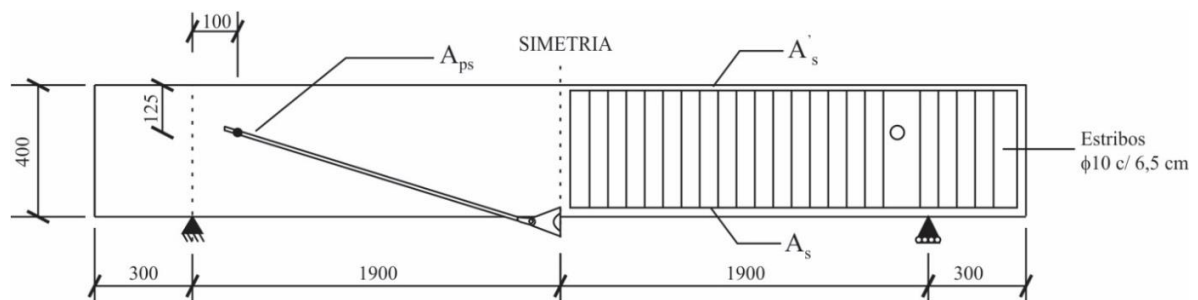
Esquema estático e armaduras para as vigas ensaiadas por Lee, Shin e Lee (2018).
